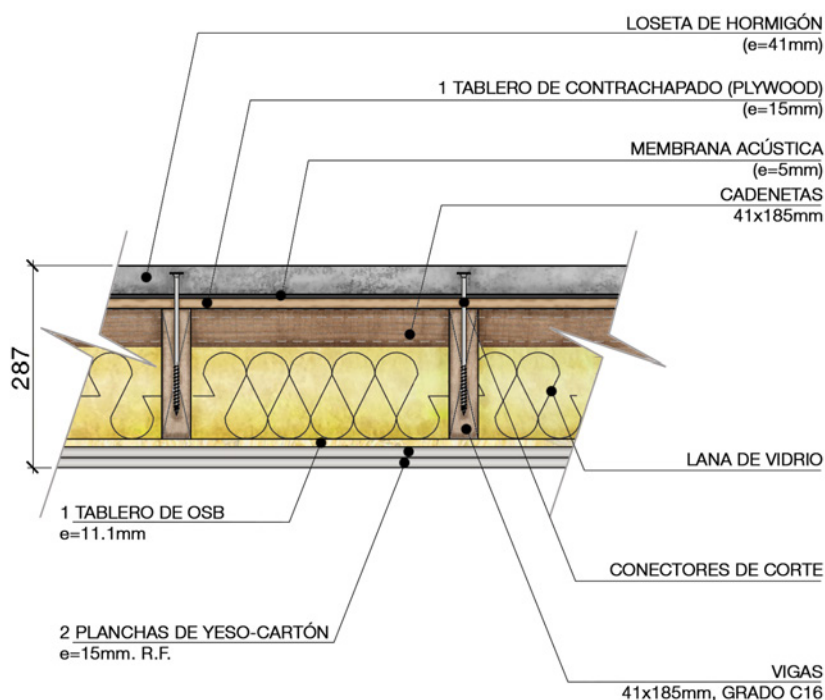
Detalle de la solución de entrepiso F-60 para el edificio Tipo A
